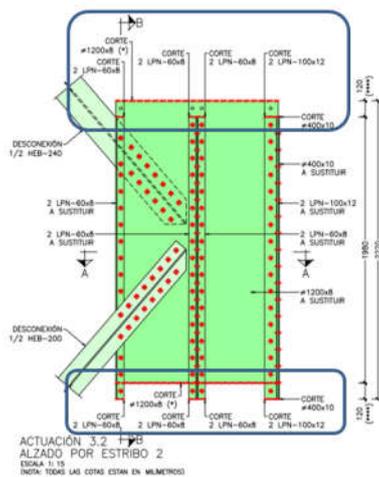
Nudo intermedio mamparo estribo 2. Soldado de chapas
